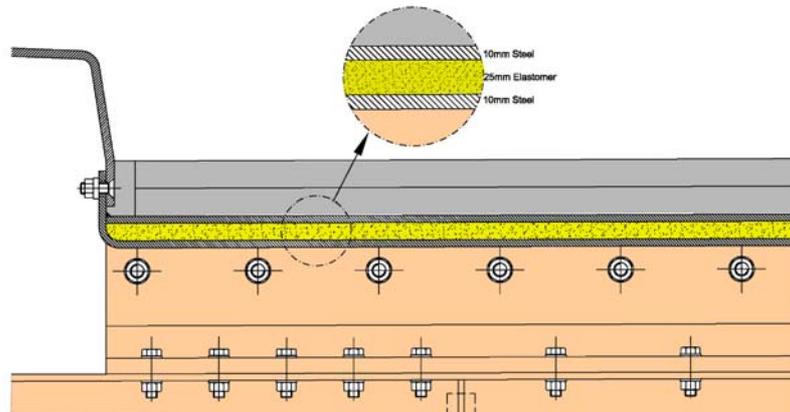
Fahrbahnaufbau in SPS-Bauweise für die Brücke Mettlach
